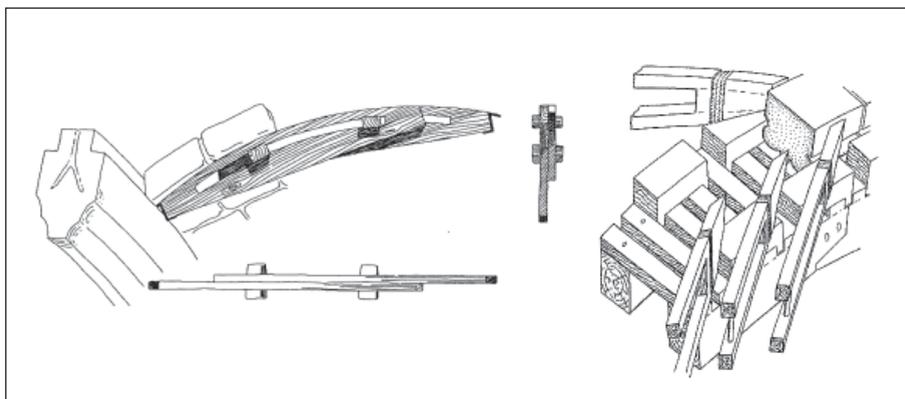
Detalle de cimbra para los nervios utilizando tablas según Fitchen 1961 y cimbra móvil para la ejecución de la plementería sobre los nervios según Viollet le Duc, 1858-68.
